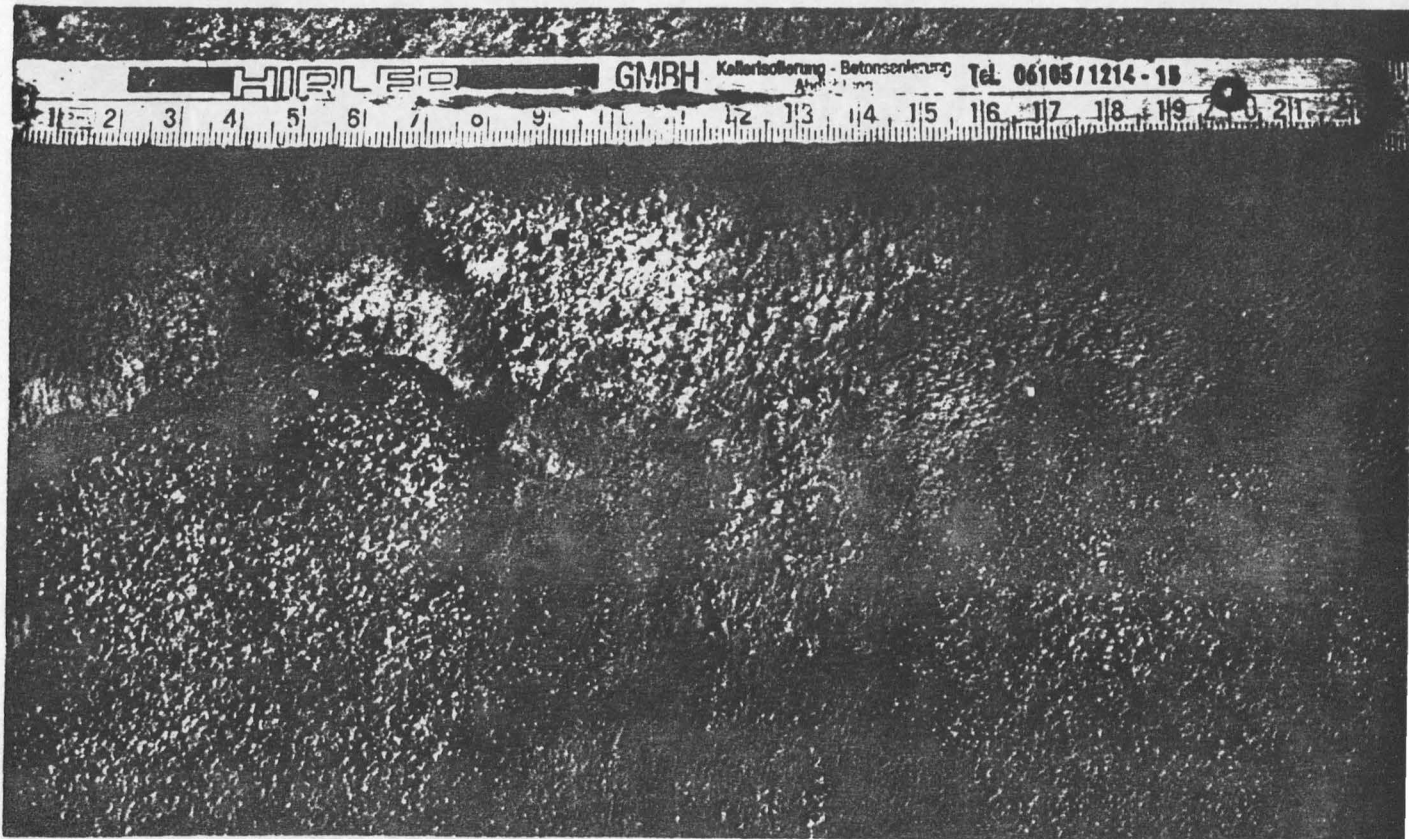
Details aus Abb. 49, Risse an der Grenzfläche Altbeton/Mörtel
